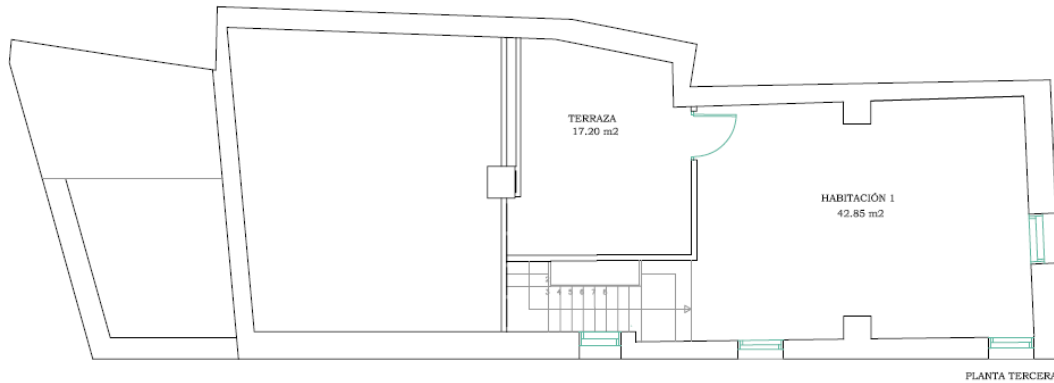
Plano distribución y superficies planta tercera (bajo cubierta) Anexo 9.2 P.9
